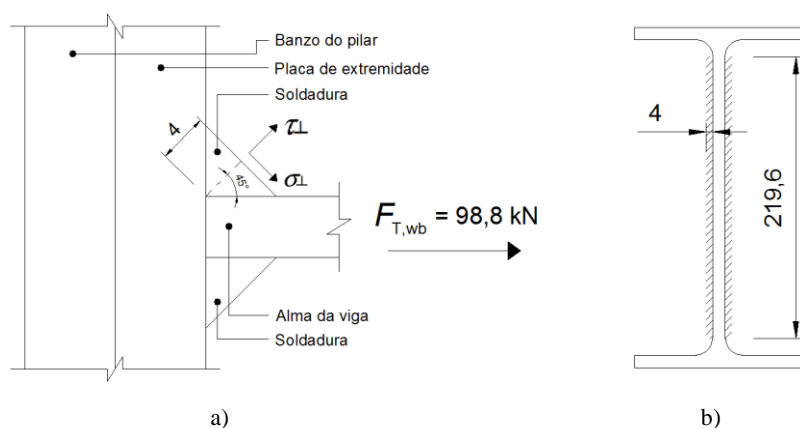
a) Corte (planta) longitudinal da alma da viga. b) Corte transversal da viga.
